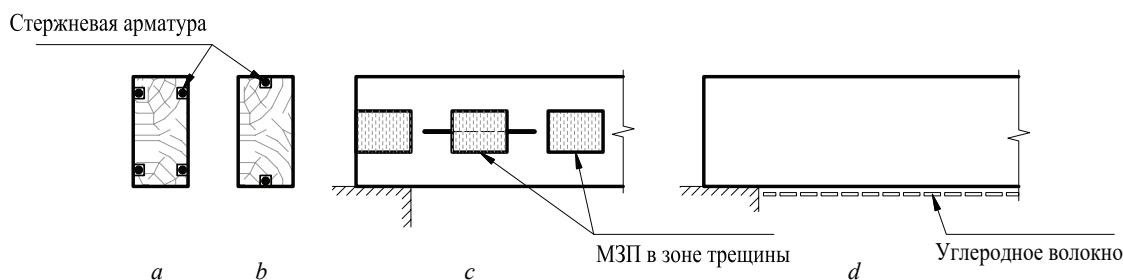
Варианты армирования деревянных балок: *a, b* — стержневой или композитной арматурой, клеиваемой в пазы; *c* — установка МЗП для ограничения развития трещин; *d* — усиление растянутой зоны балки углеволоконной лентой
